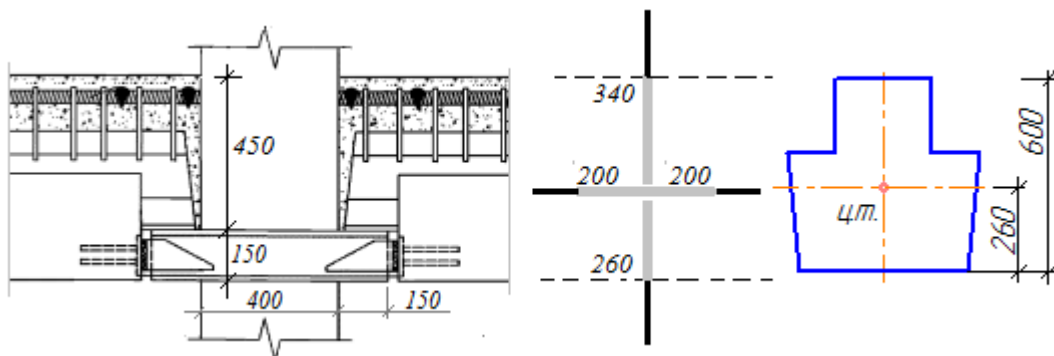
К определению размеров поперечного сечения колонн и ригелей для их моделирования в расчетной схеме в соответствии с рекомендациями СП 356.1325800.2017
